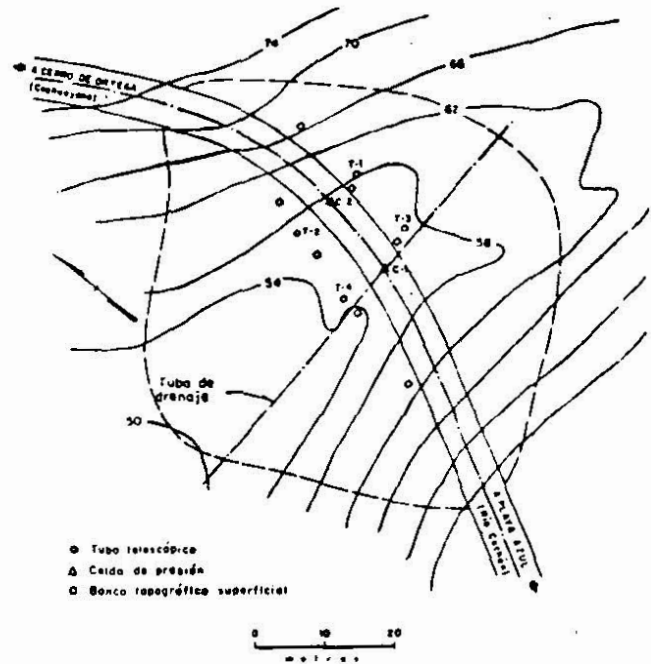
Planta de localización de la instrumentación dispuesta en el pedraplén "La Plazuela".
